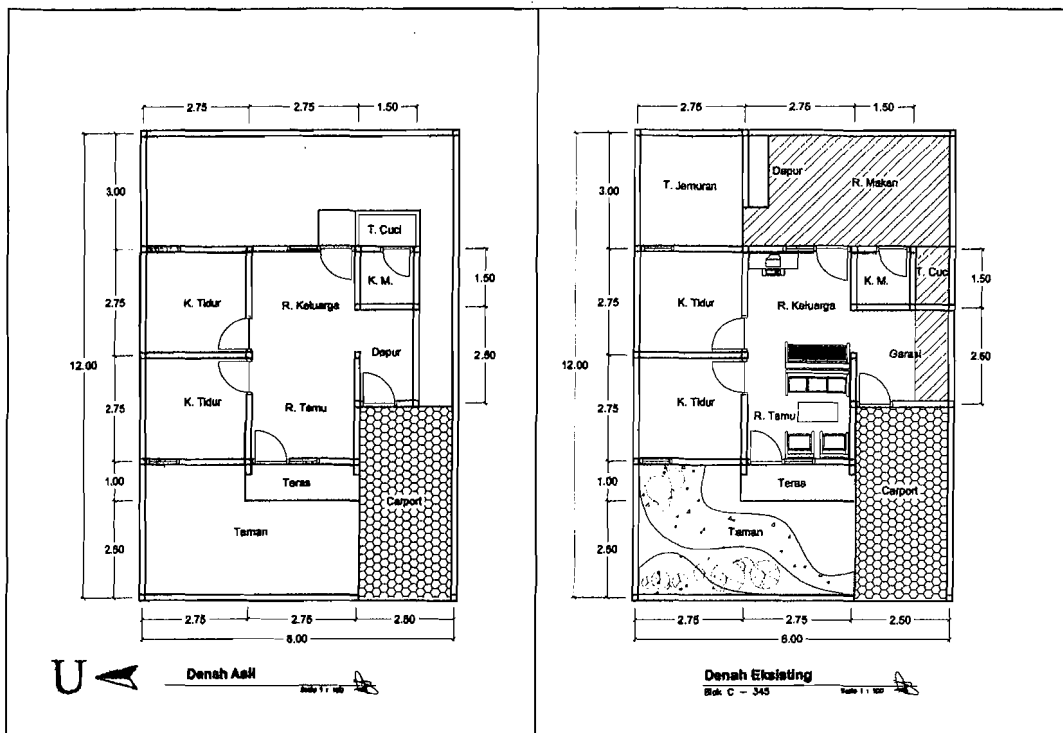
Denah Asli dan Denah Eksisting Blok C 323 yang mengalami penambahan ruang dapur dan pelebaran ruang garasi.
